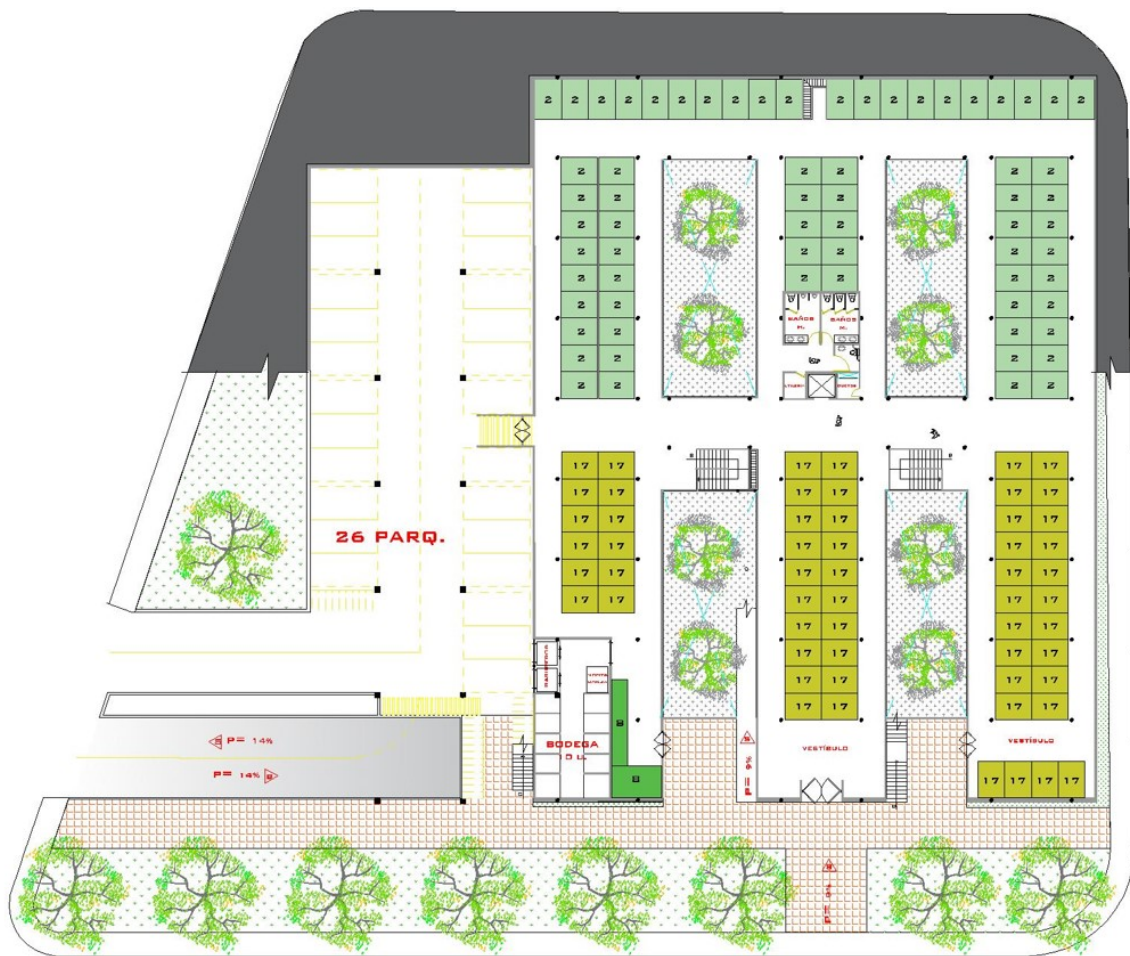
Nuevo giro Comercial, Planta baja Fuente: Fabrizio Benenaula.
